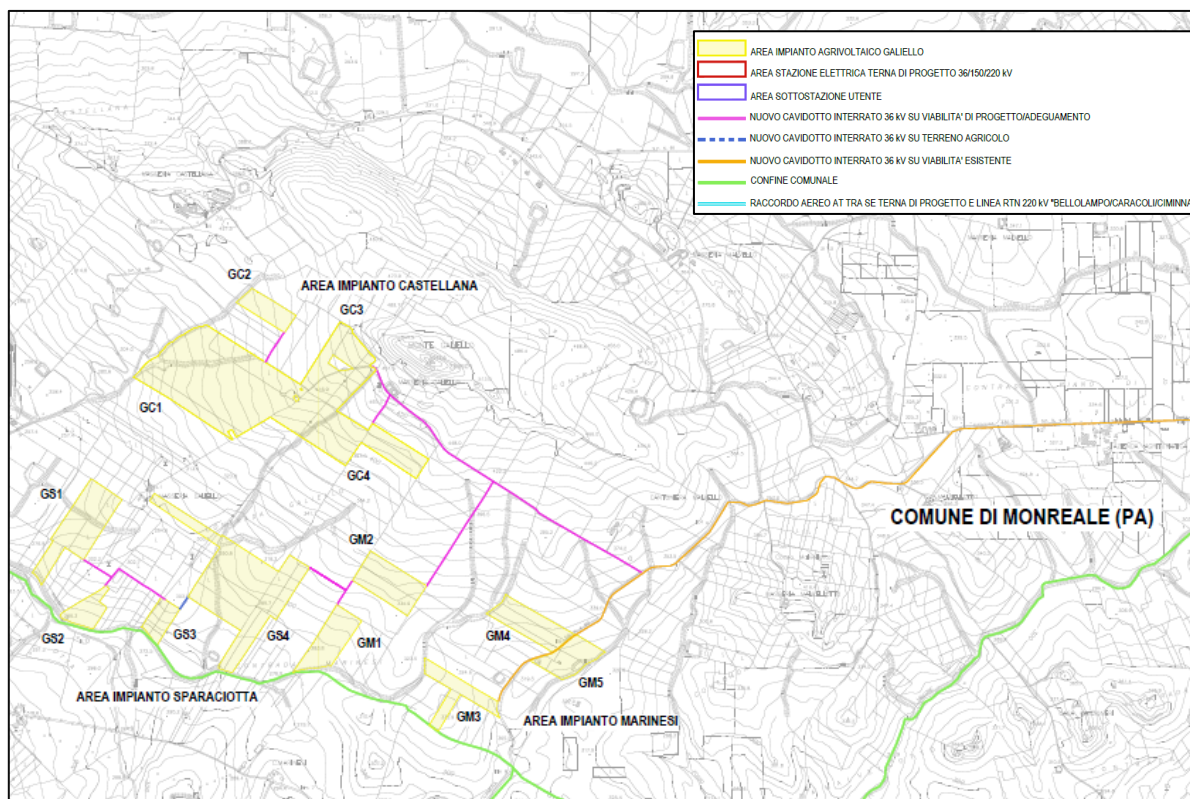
Inquadramento opere in progetto (impianto) su CTR (Scala 1:10.000)
